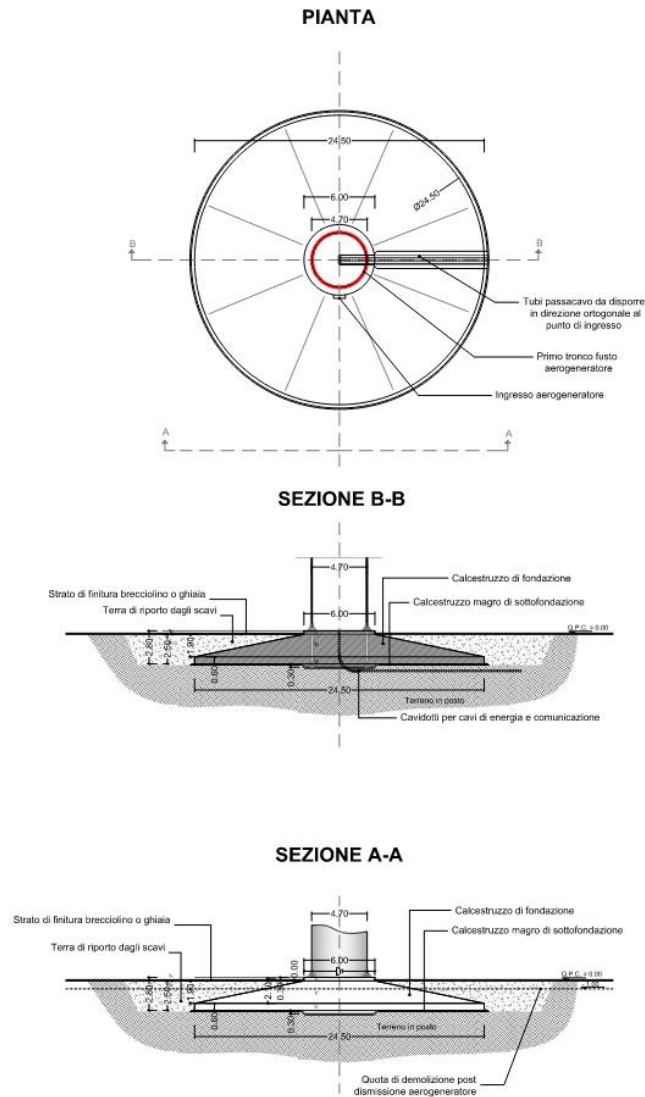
Pianta e sezioni della fondazione dell'aerogeneratore
